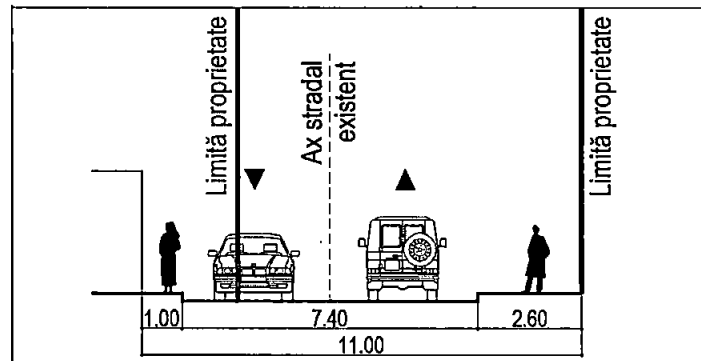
Profilul stradal Aleea Daliei (zonă de acces în zona reglementată prin sud)
